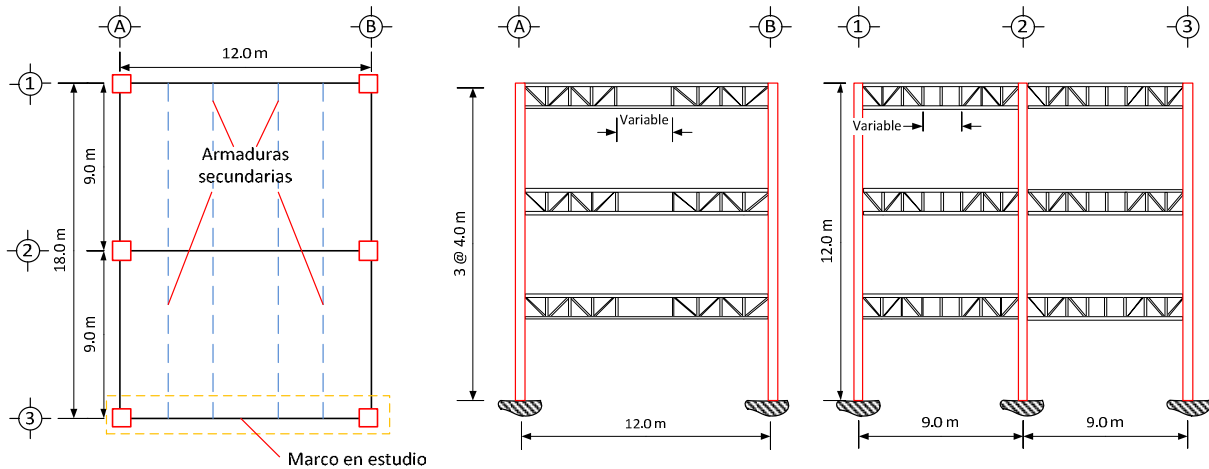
Configuración geométrica en planta y elevación del edificio en estudio
